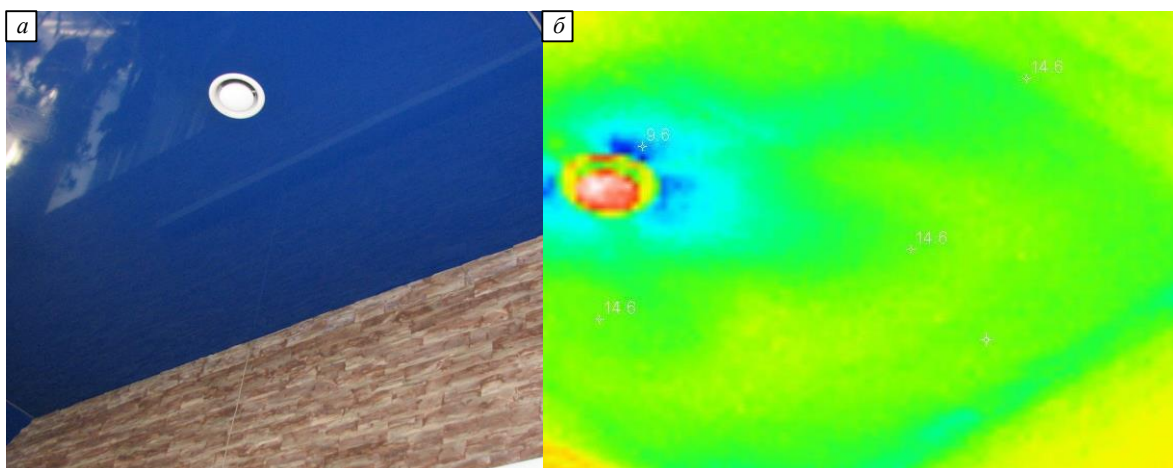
Скрытые дефекты тепловой изоляции перекрытия:
